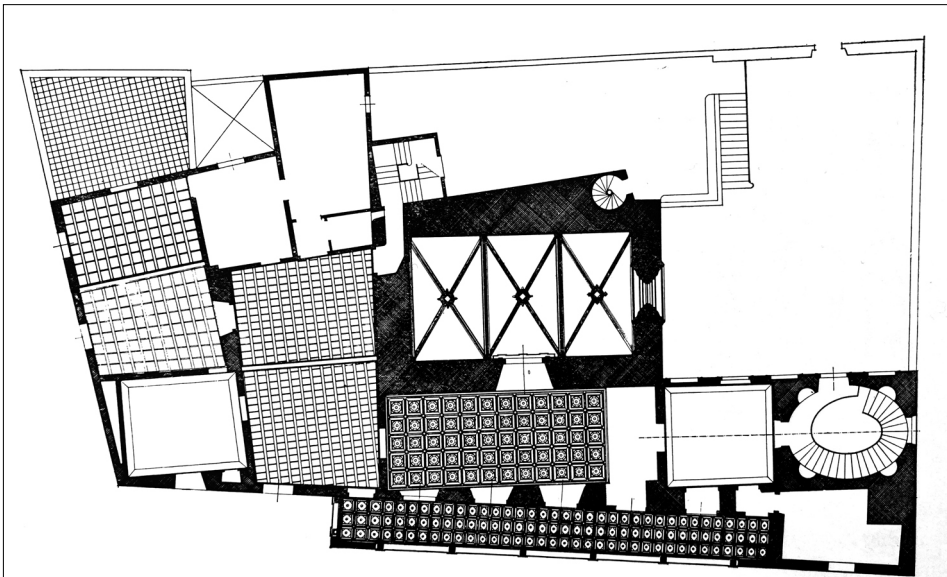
Anònim, plànol de la planta noble del Consolat de Mar.
